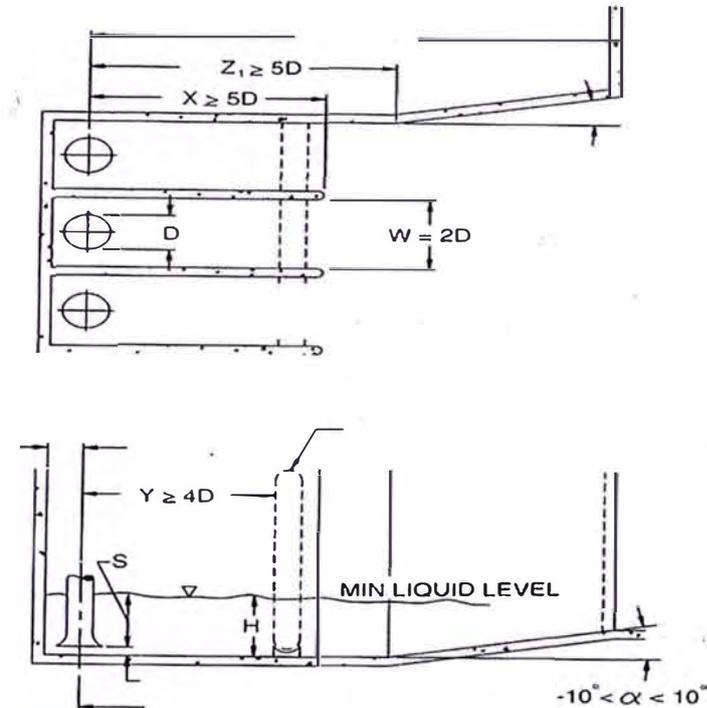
Recommended intake structure Layout "HI Pump Intake Design 1998"
